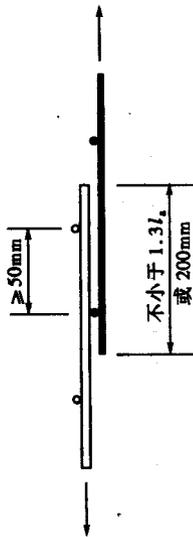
带肋钢筋焊接网搭接接头
